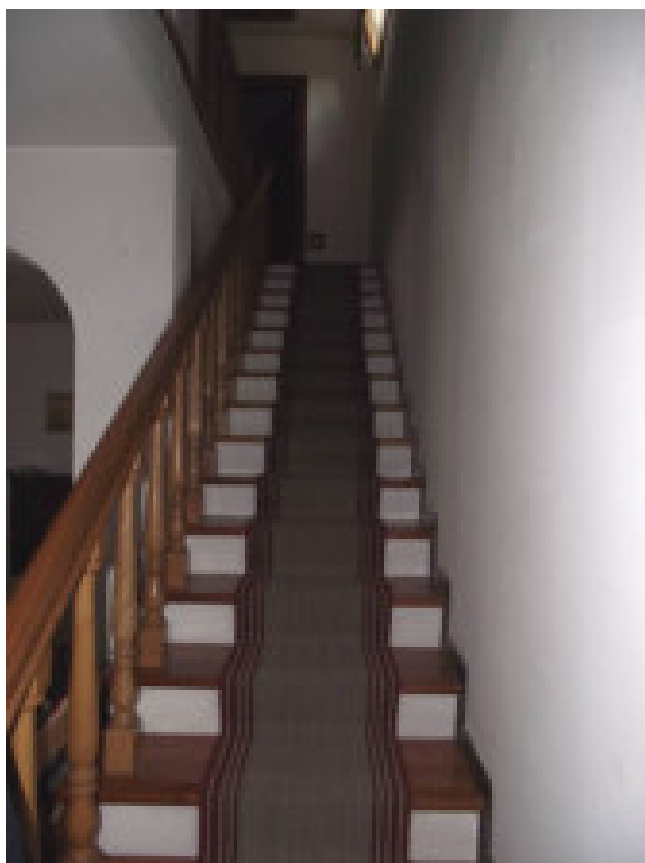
17 - Scale di accesso e corridoio al piano primo
